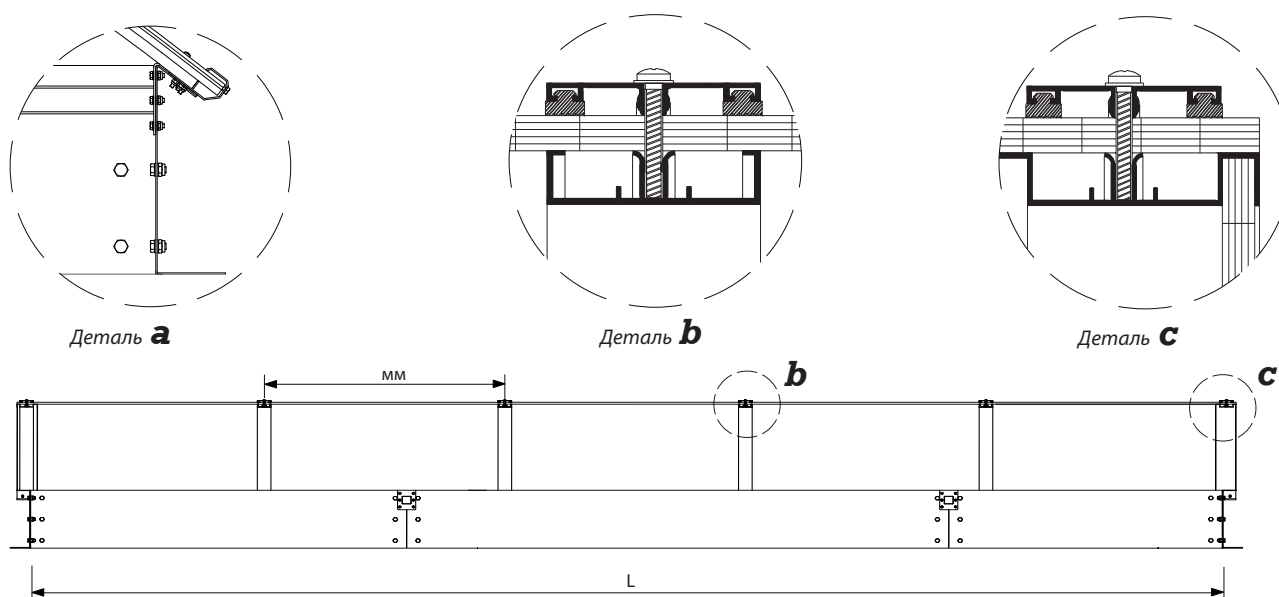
Продольное сечение B-B световой полосы с арочным сводом
